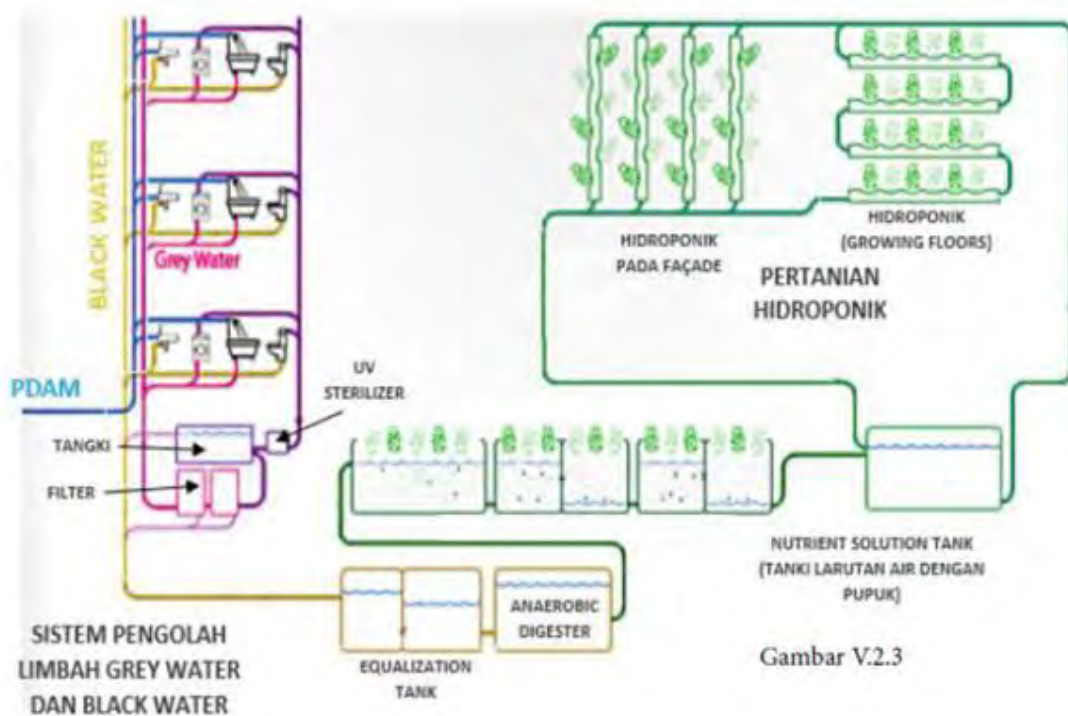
Diagram sumber air bangunan :ilustrasi pribadi)
